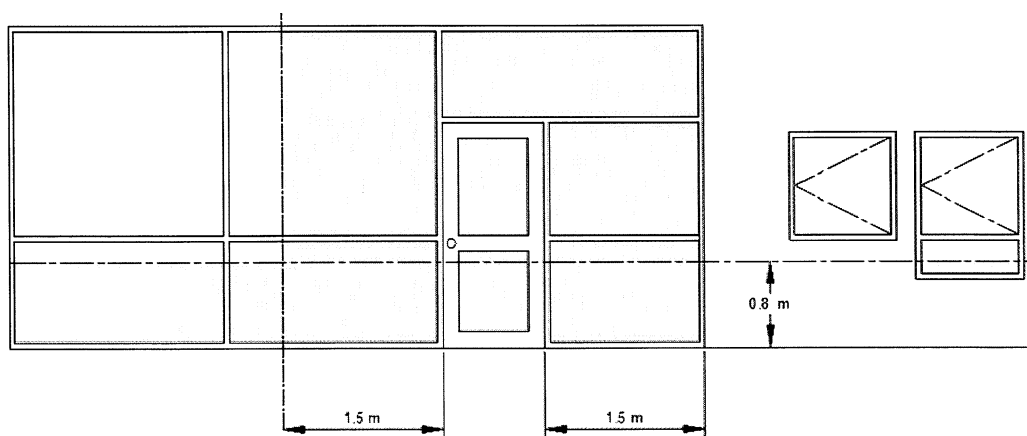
Zonas críticas de aplicação de envidraçados
